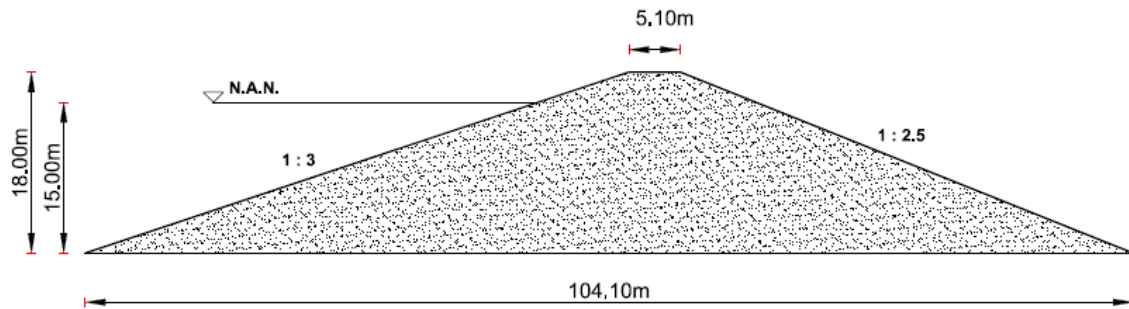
1 Dimensiones de la presa de tierra Macul 1
